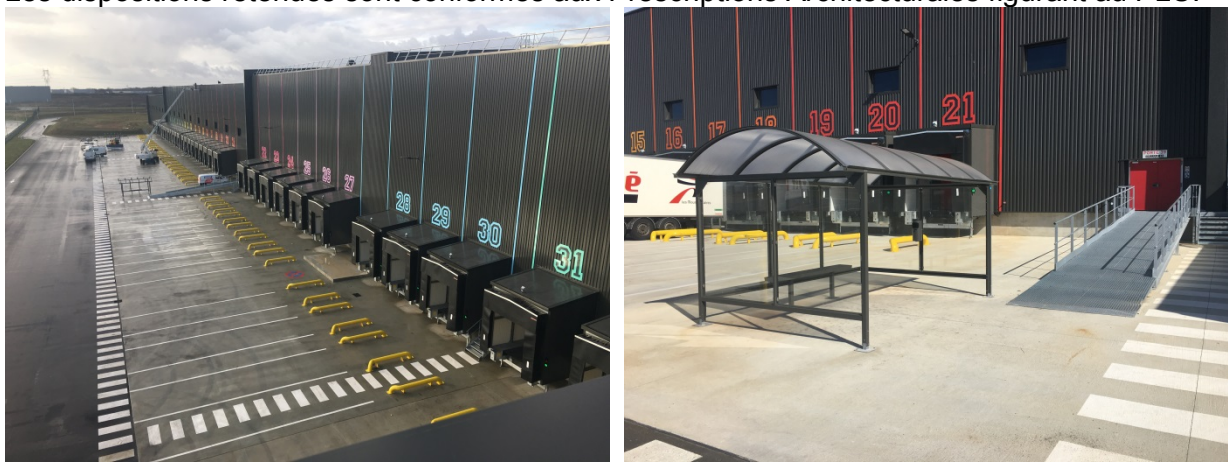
exemple de façade ITM – vues générale et rapprochée
